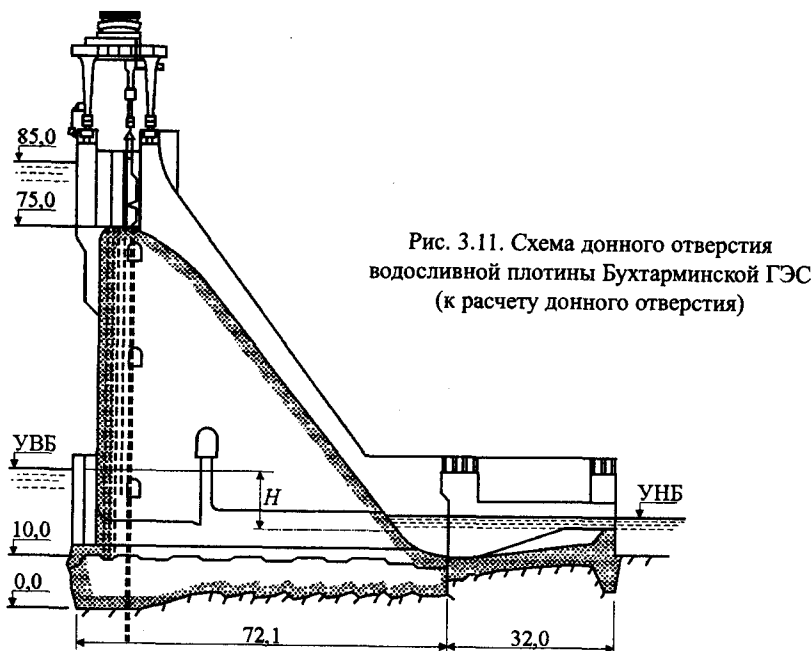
Схема донного отверстия водосливной плотины Бухтарминской ГЭС (к расчету донного отверстия)
